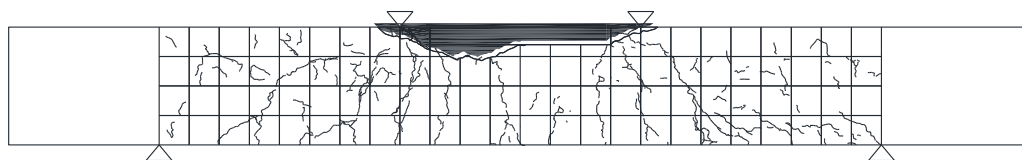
ジャンカ梁試験体のひび割れ状況
